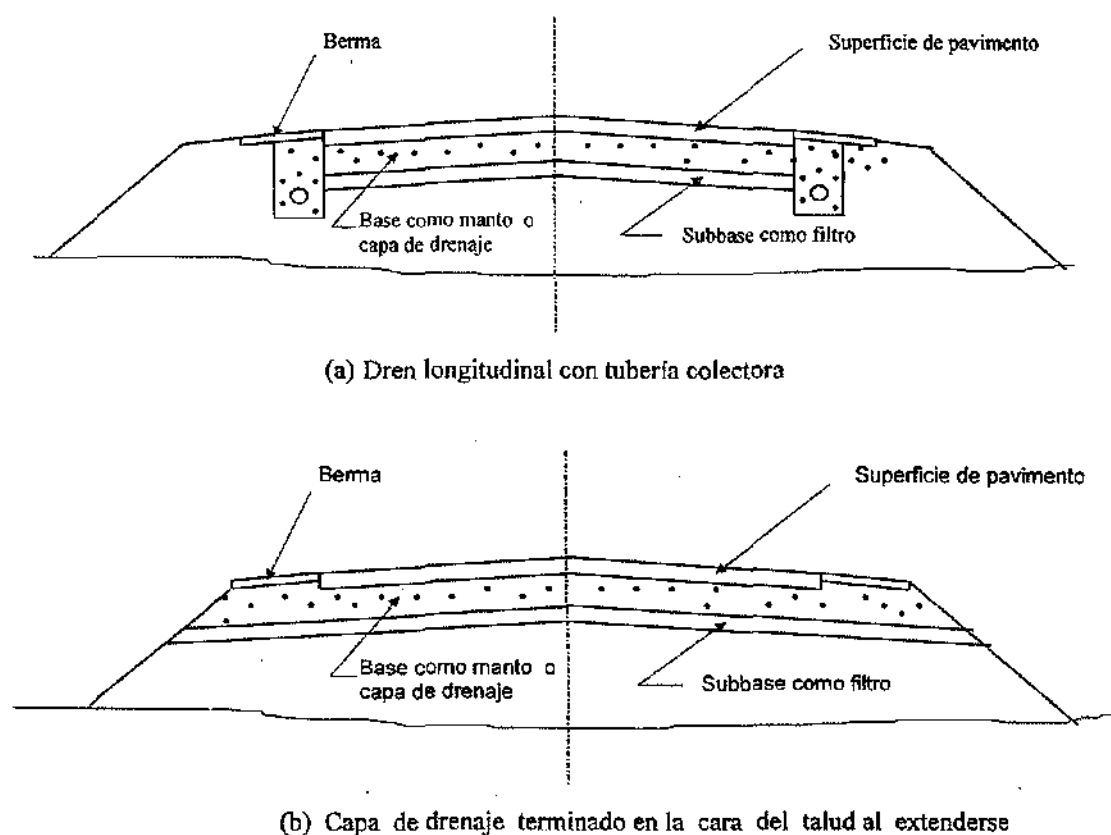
Manto de drenaje con un dren longitudinal alternativo
